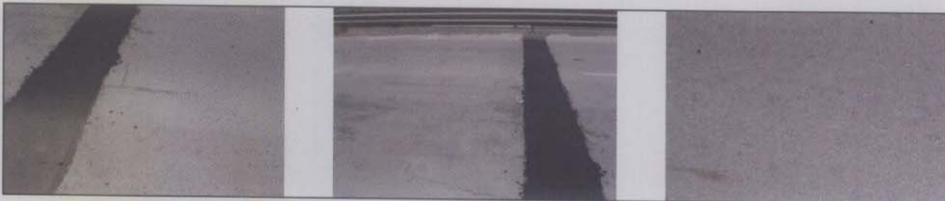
Estado de la carpeta de desgaste en servicio en puente sobre A° Los Pozos. Izquierda y centro: fisuras de la losa de aproximación contra la junta de dilatación, derecha: sector con hormigón N2
